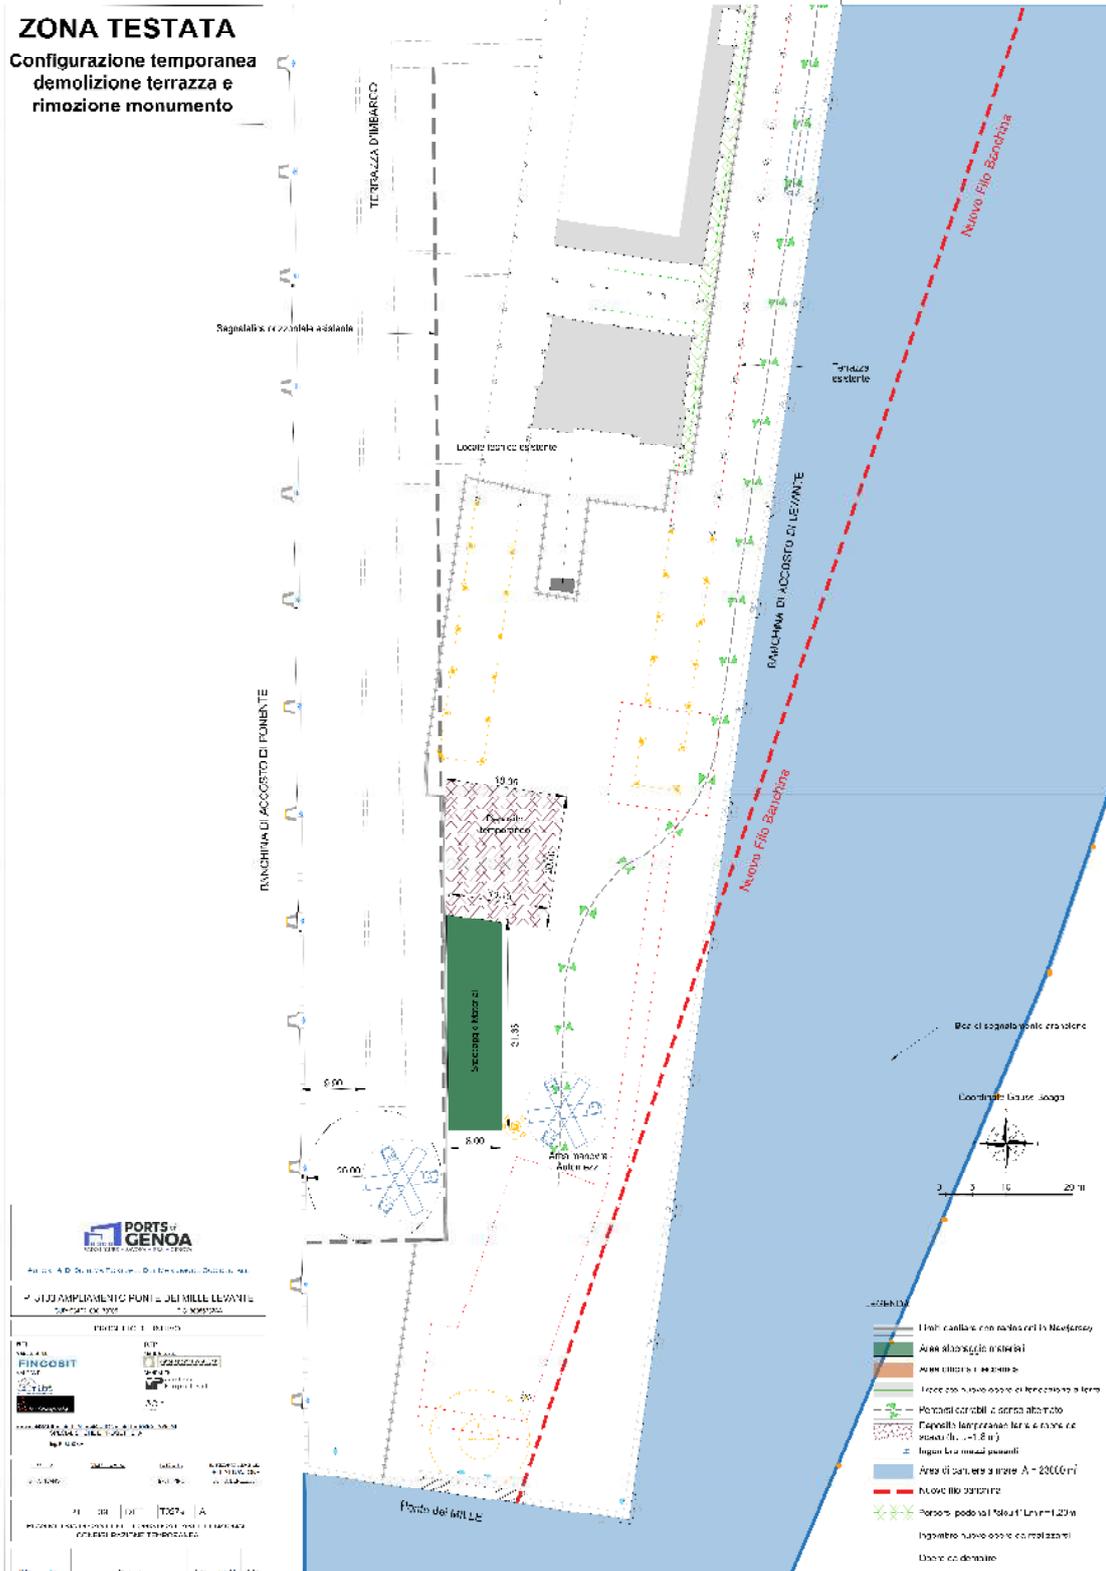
Planimetria di cantiere – logistica e aree funzionali configurazione temporanea
